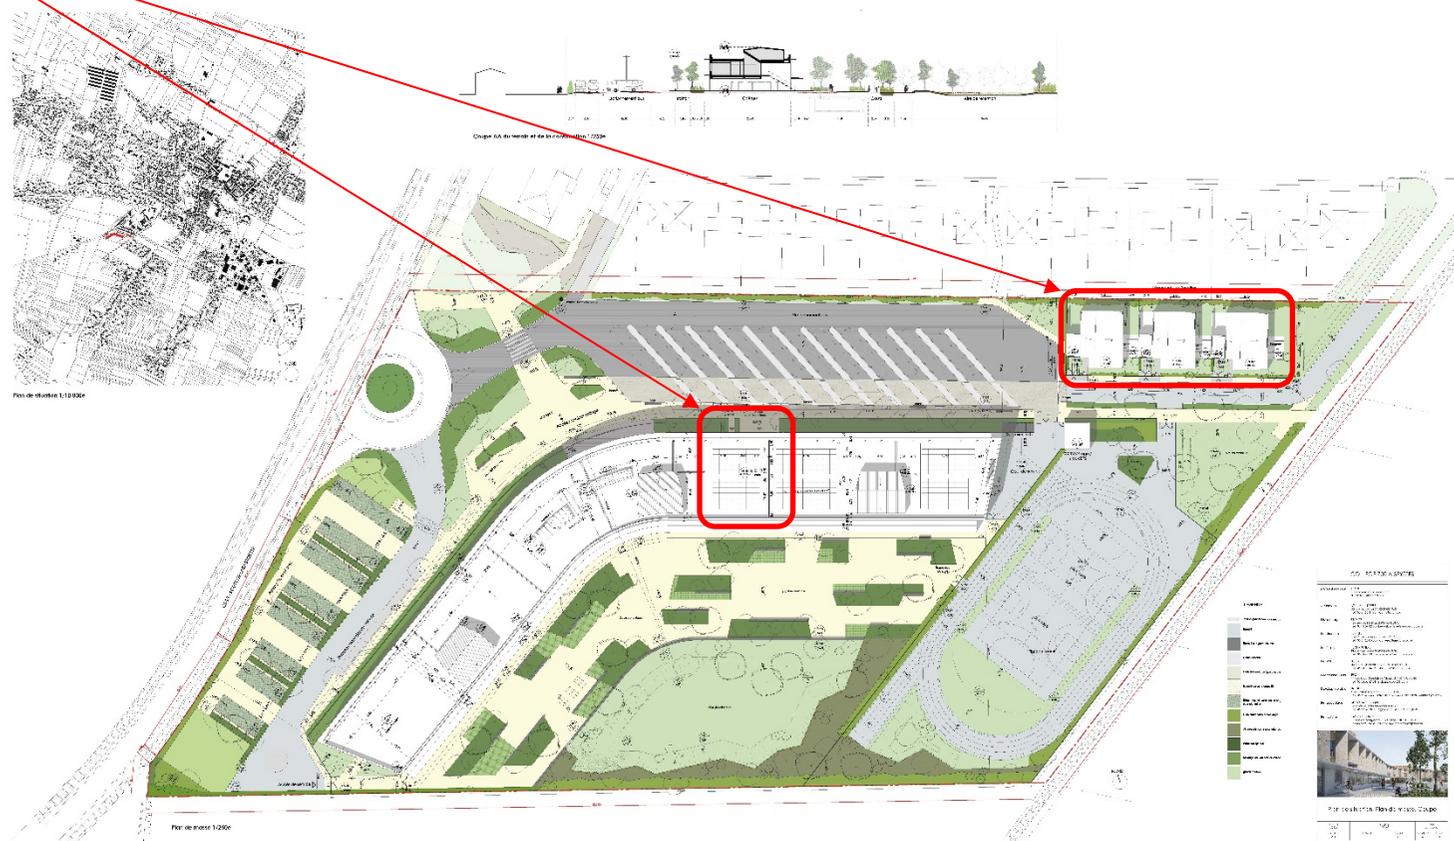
Plan de masse du collège phase PRO, source Véronique Joffre Architecture
